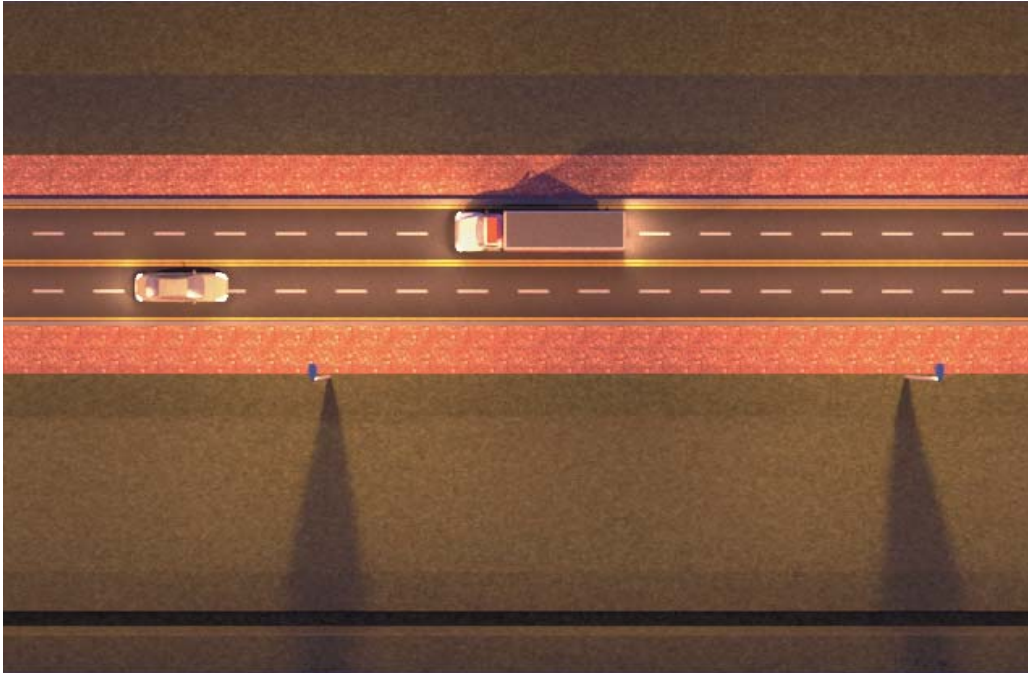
Vista en planta de la carretera tipo A2 con sistemas de iluminación
